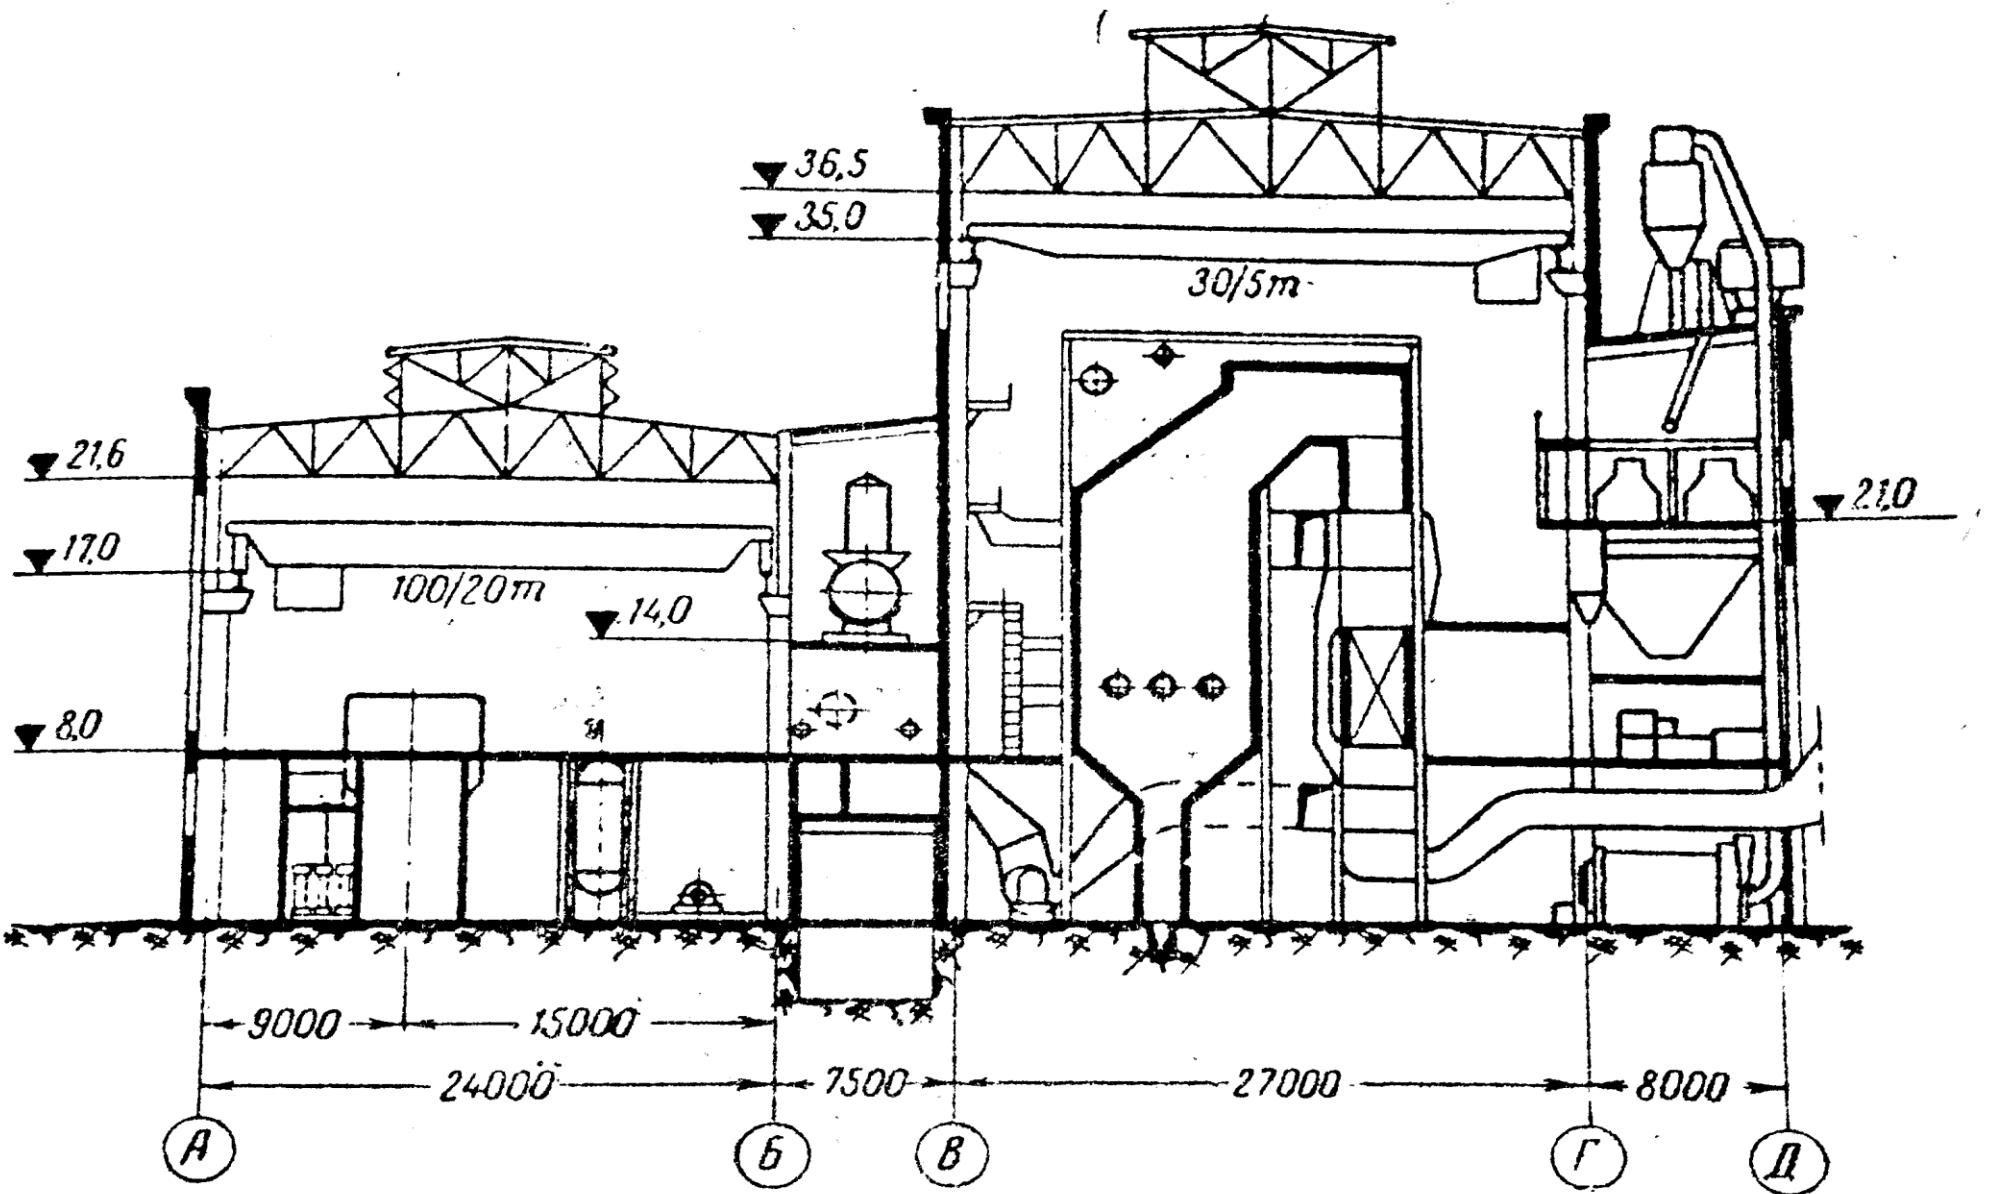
Компоновка главного корпуса с наружной бункерной этажеркой (поперечный разрез).
